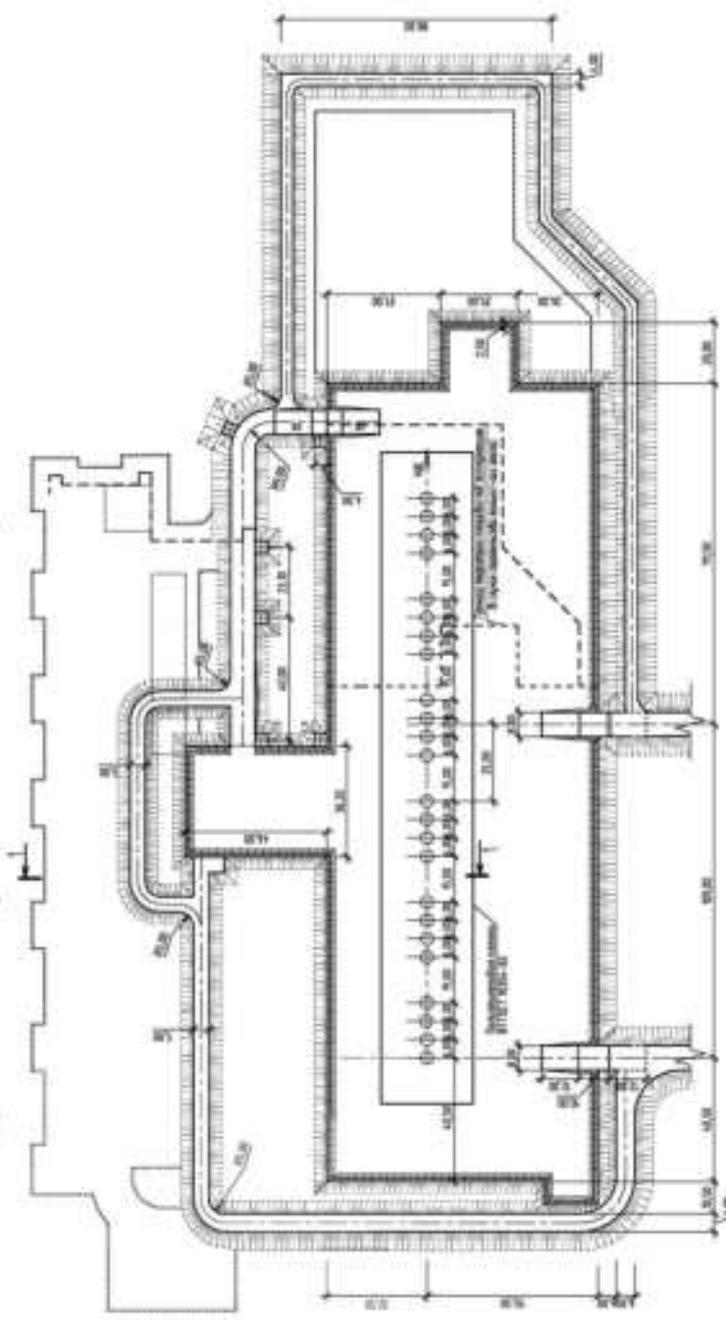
Схема технической реконструкции площадки кустовой на полове.
